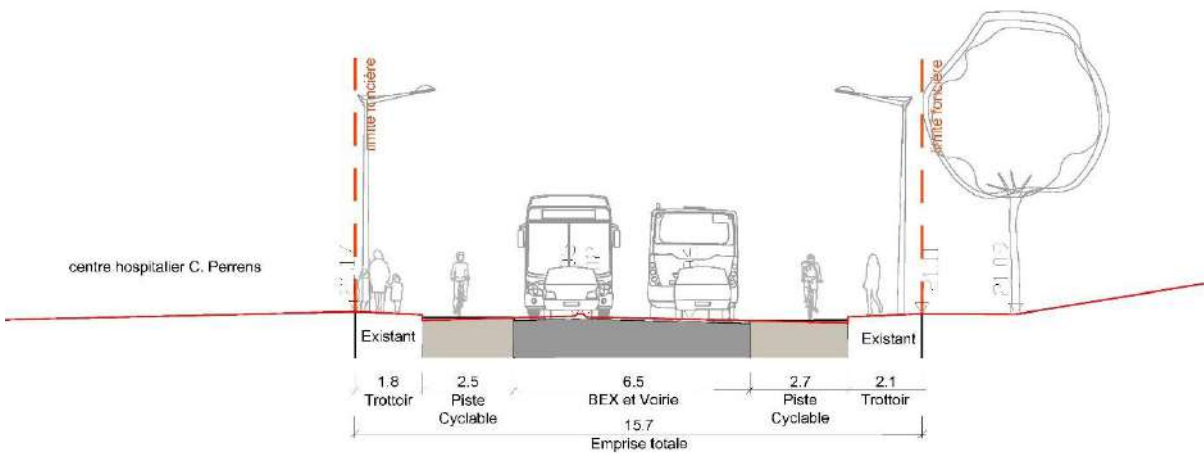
Coupe type sur la rue de la Béchade en section courante
